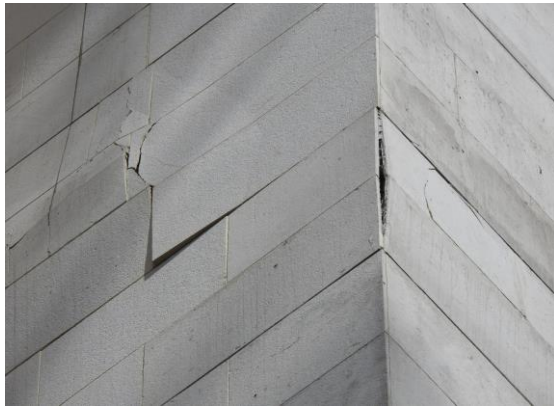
Detalle vista exterior deterioro de abombamiento y grieta en enchape.
